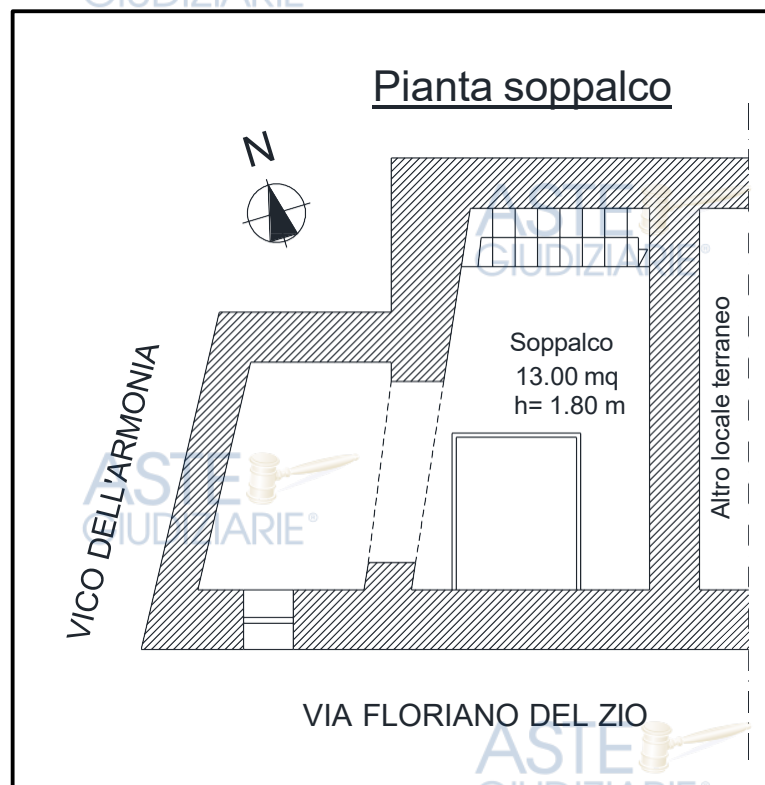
Pianta del soppalco interno al locale commerciale Lotto 2 (Fig. 105, p.lla 3190, sub. 6)
